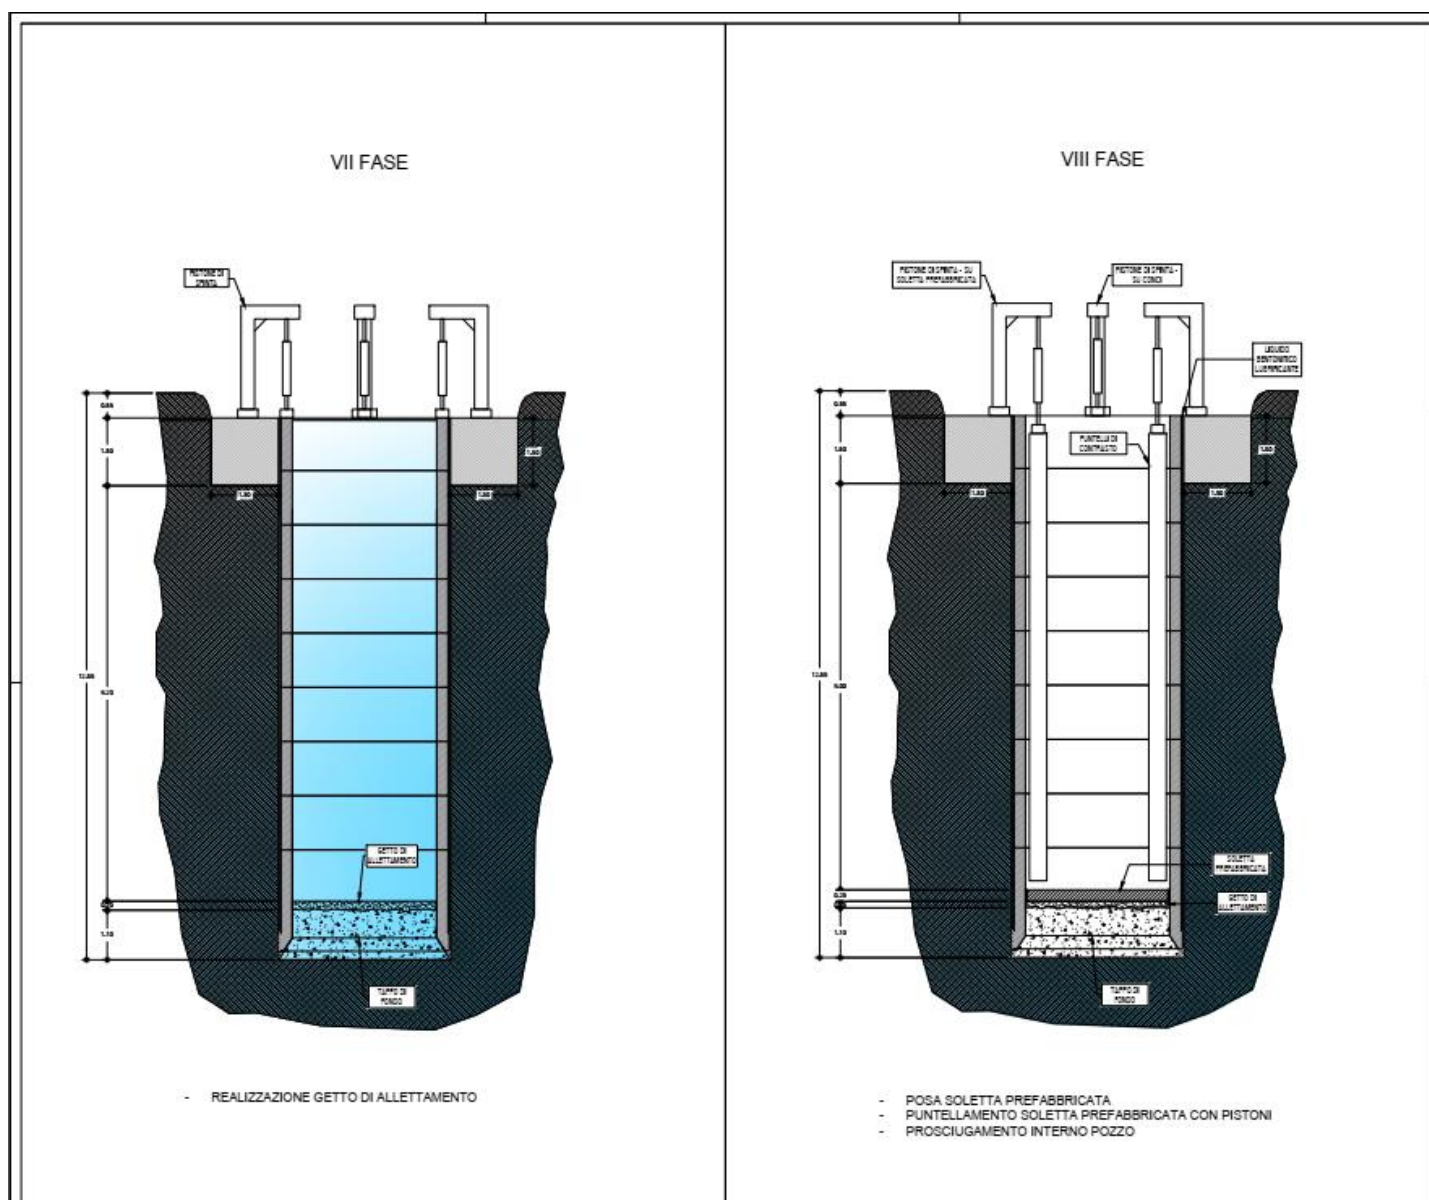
E : Schema tecnico realizzazione pozzo autoaffondante
